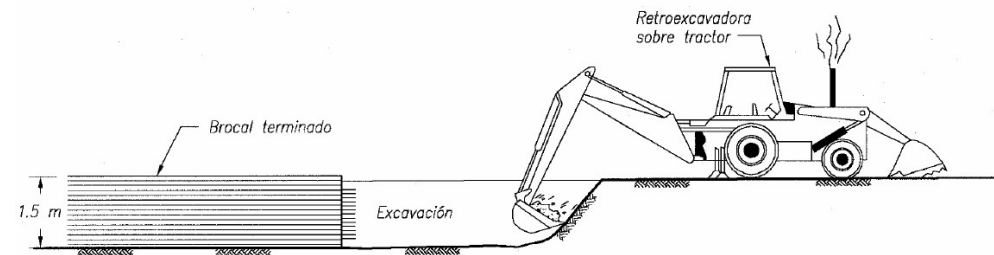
PREEXCAVACIÓN PARA LA CONSTRUCCIÓN DE BROCALES PARA MUROS MILÁN EN ZONAS SIN INTERFERENCIA
